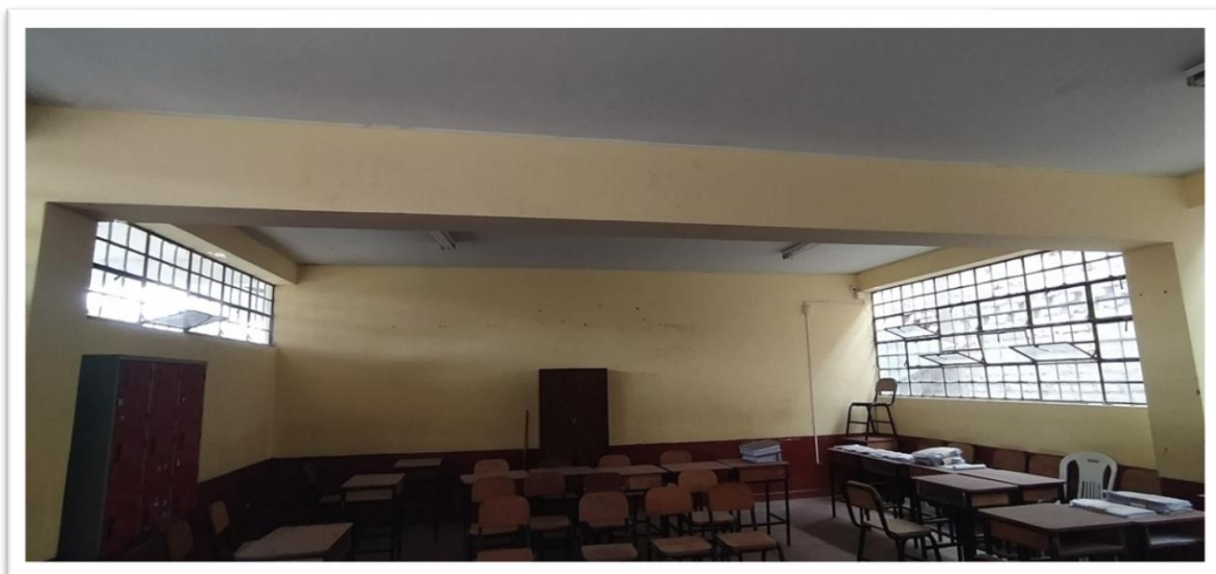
Muros de albañilería confinada reforzados con columnas y vigas del pabellón 11.
